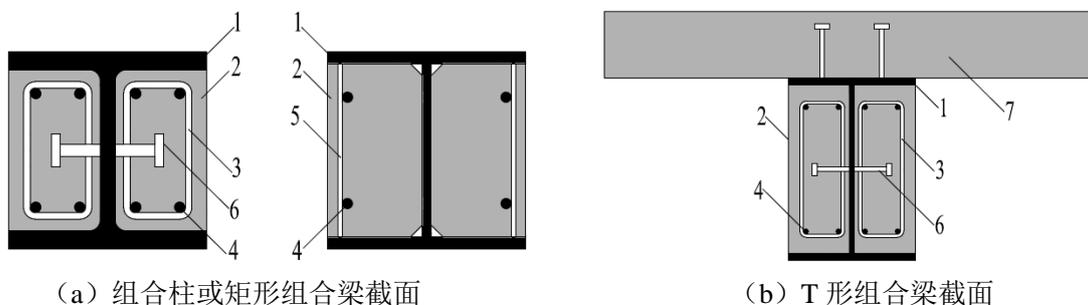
部分包覆钢混凝土组合结构截面形式
